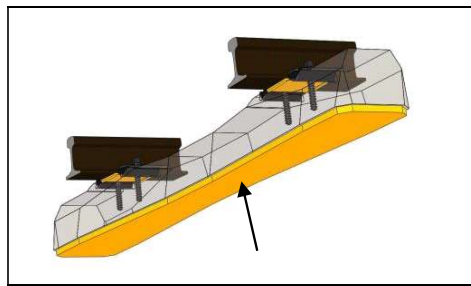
Mit einer Schwellensohle ausgerüstete Betonschwelle
